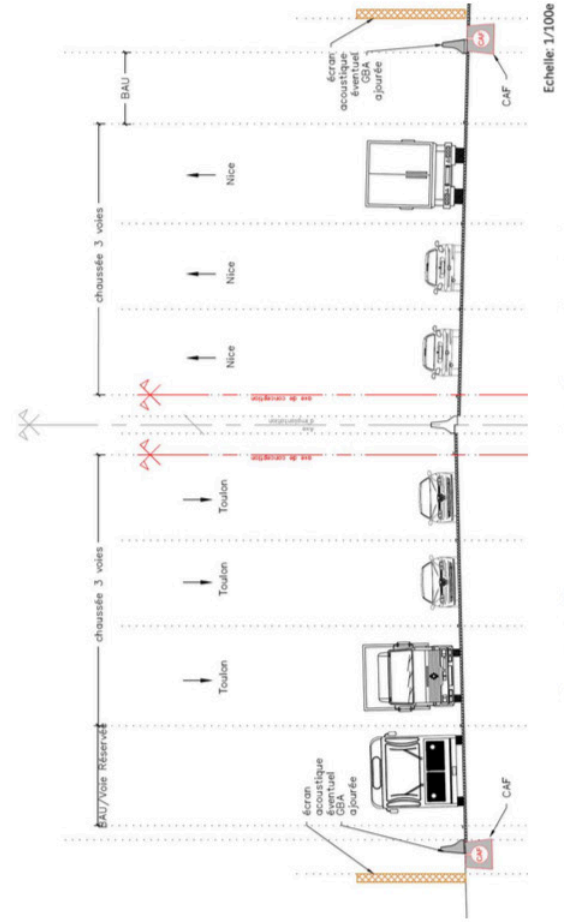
Profil en travers type – Section Les Fourches vers La Bigue, création de la collectrice à une voie
